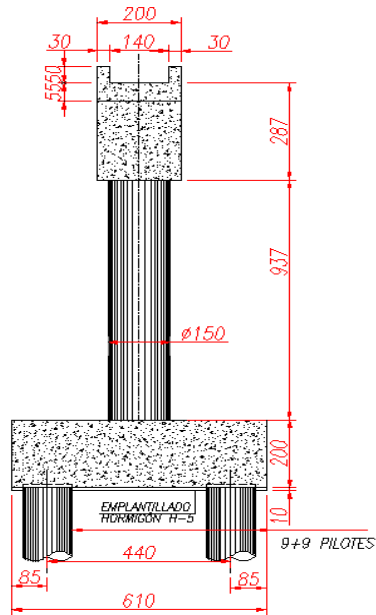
Detalle en centímetros elevación lateral cepa 4.
